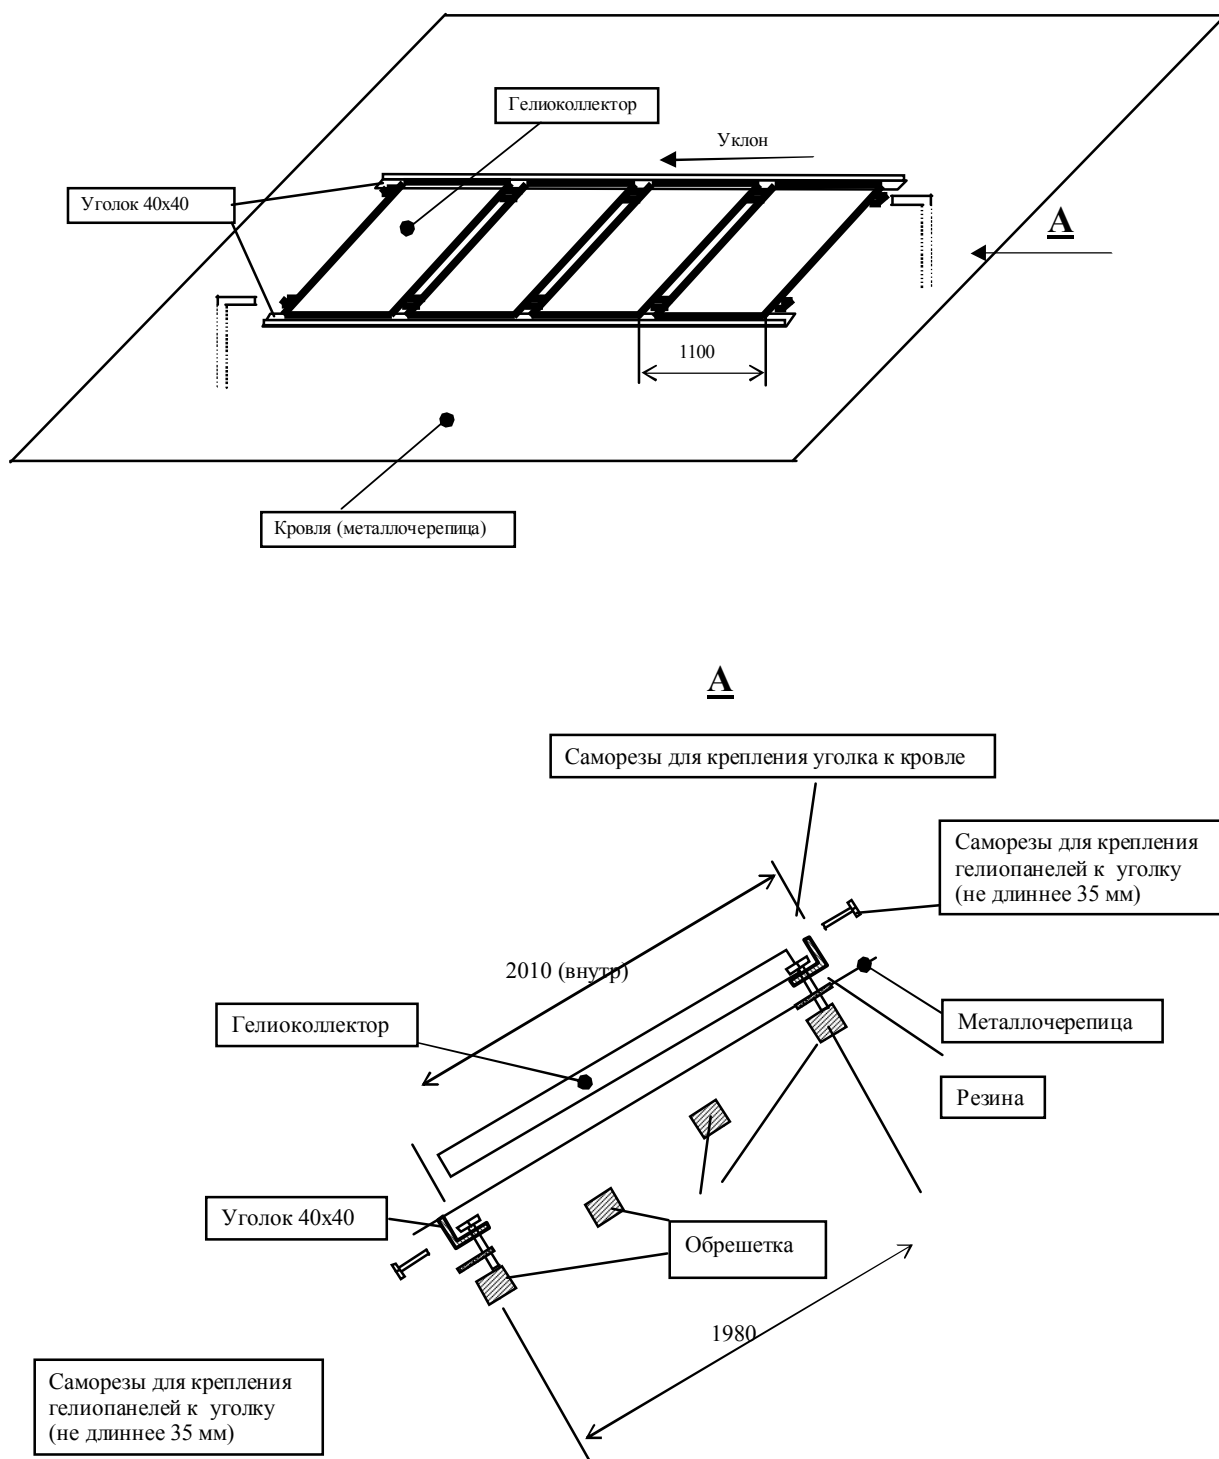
Схема монтажа гелиопанелей на наклонной кровле. Покрытие – металлочерепица.
